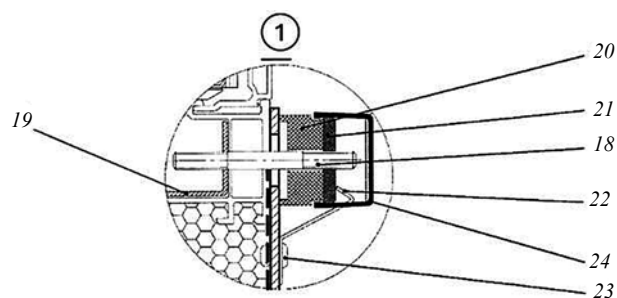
, б. Модель легкобрасываемой конструкции⁹, легкобрасываемый элемент, разрушаемый узел крепления рамы: 18 — шпилька; 19 — стальной армирующий профиль; 20 — дистанционная распорная втулка; 21 — разрушаемый элемент; 22 — пружинный фиксатор; 23 — заклепка; 24 — защитный колпак
